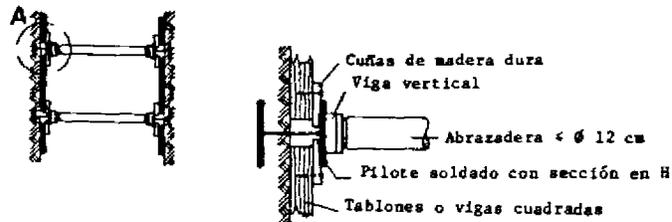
6: Entibado horizontal con vigas de madera y pilotes soldado con sección en H
